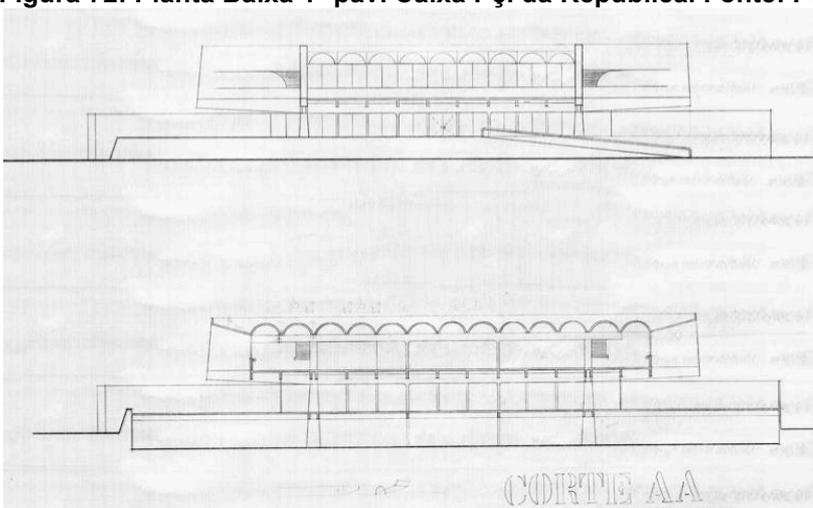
Cortes aa' e Fachada Caixa Pç. da República. Fonte: Pontual Arquitetos;
